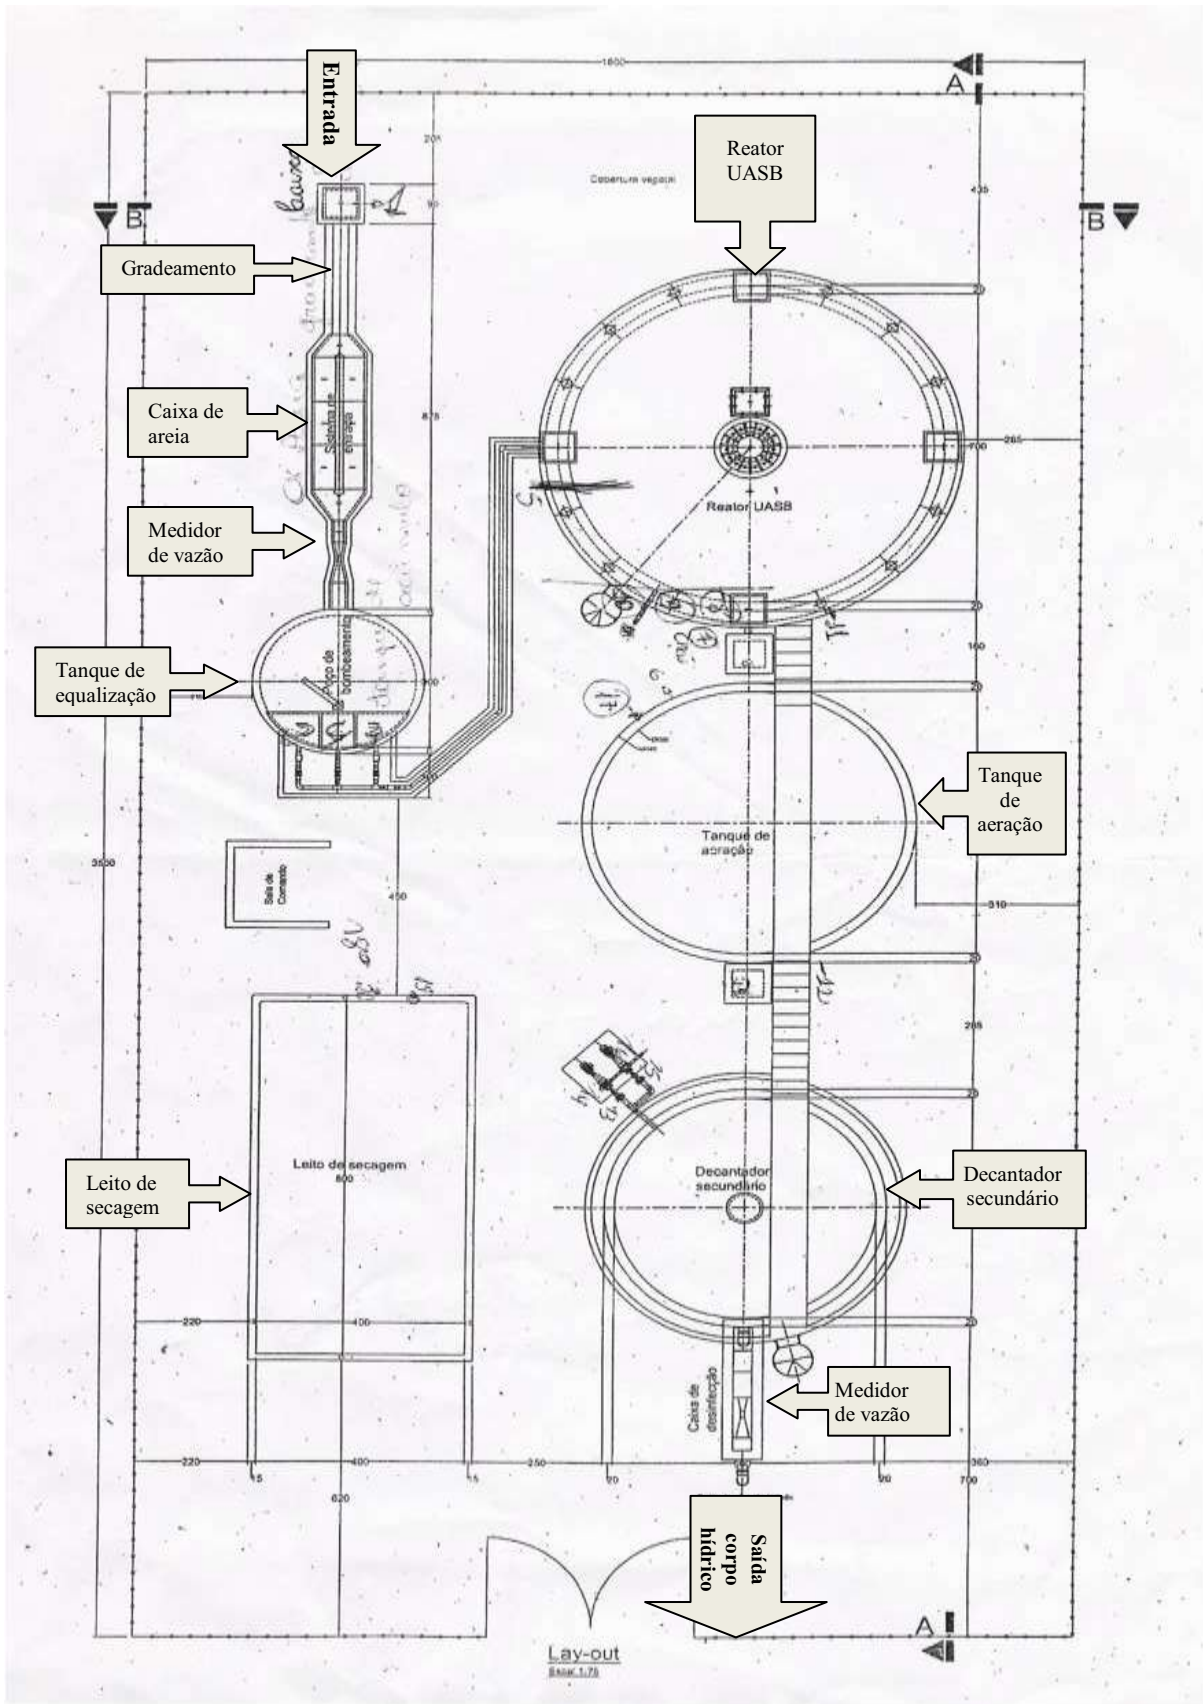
Planta baixa da ETE da Universidade de Passo Fundo.
